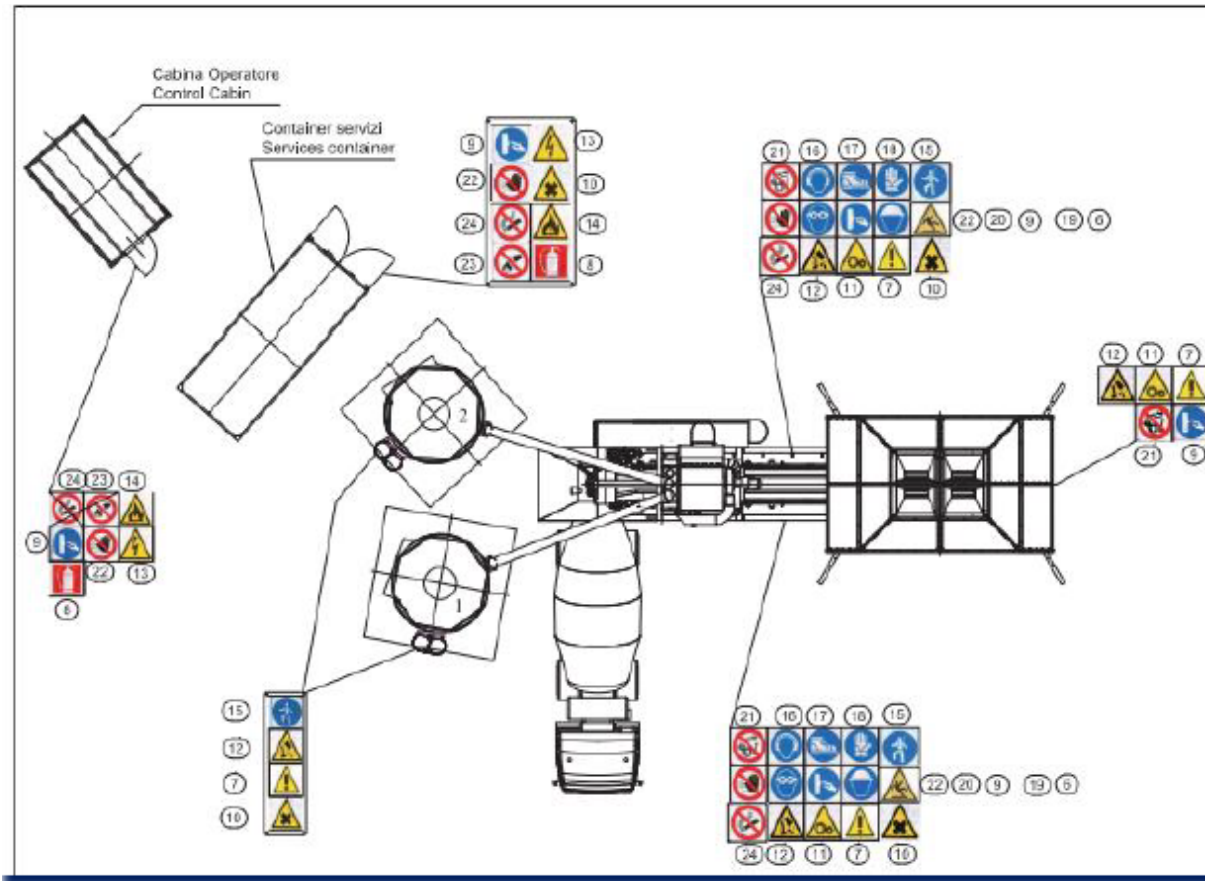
Planvendosja e Impjantit te prodhimit te betonit tip SIMEN
